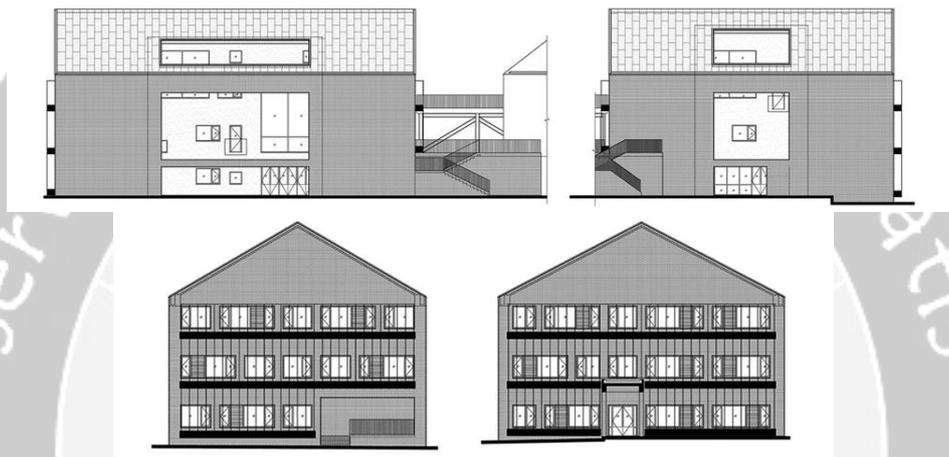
Potongan Bangunan Pengajaran Deyang School
